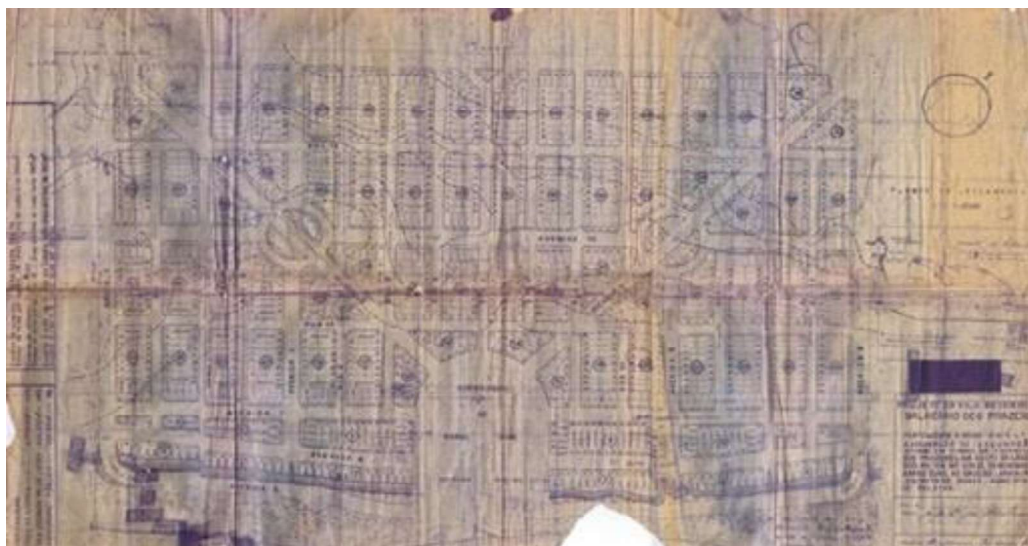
Planta do Projeto Vila Residencial Balneário dos Prazeres
